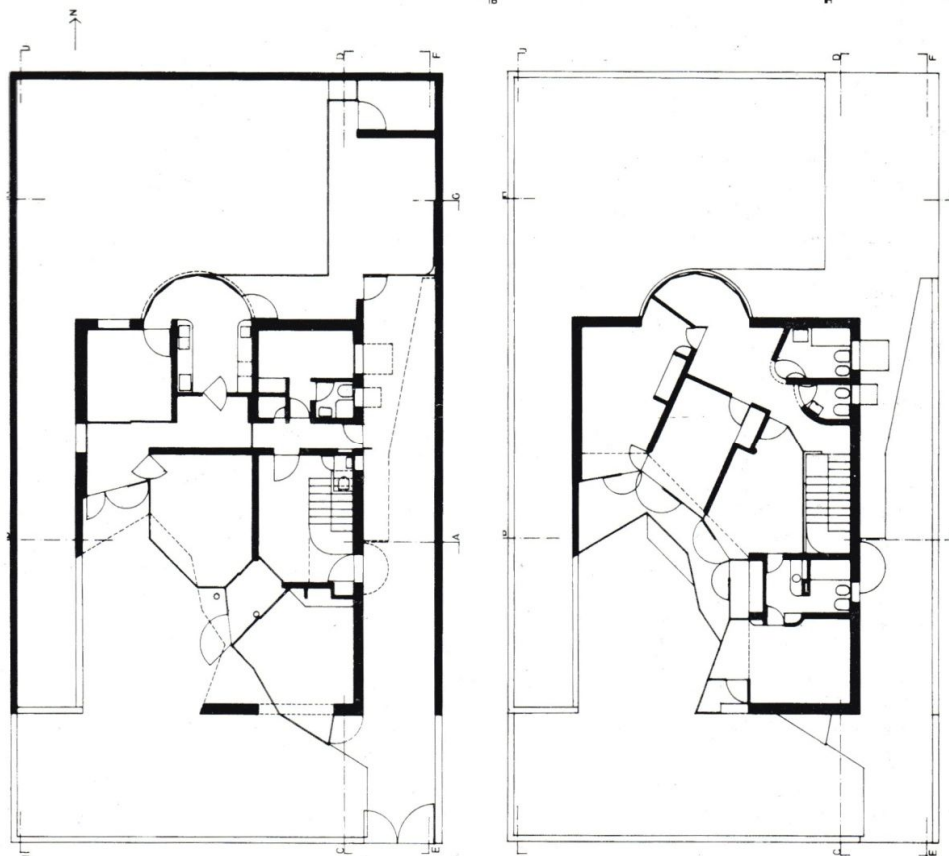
e 85- Álvaro Siza Vieira. Planta do piso 1 e do piso 2, da casa Beires. Sem escala.
